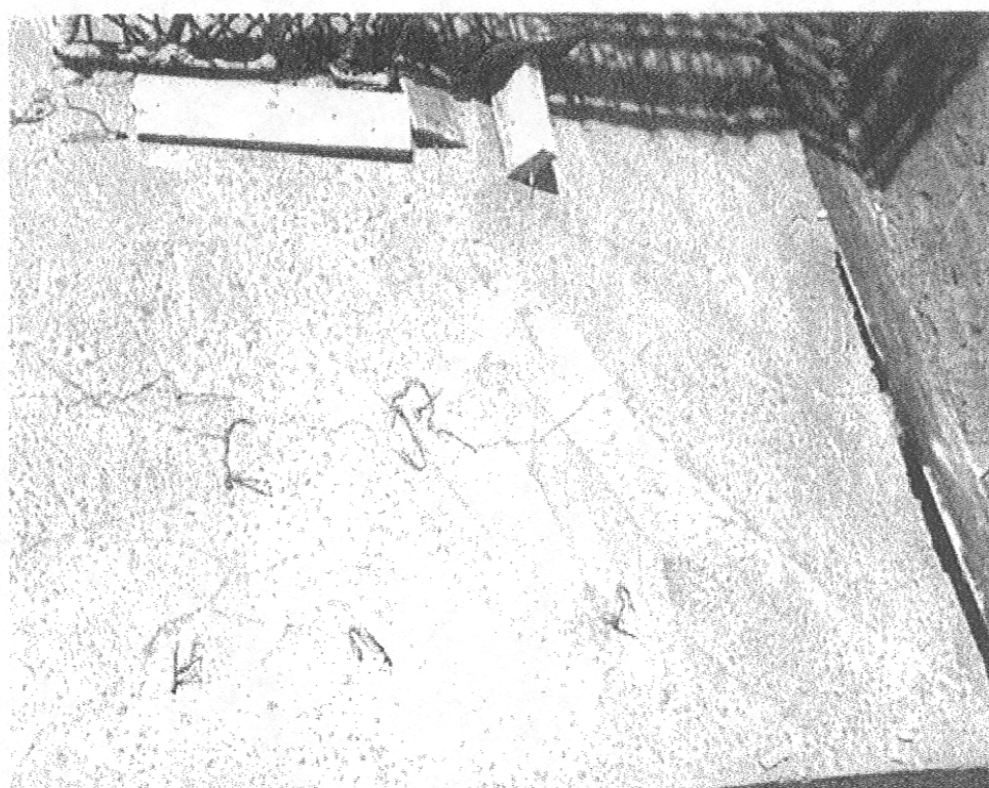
Típica contracción plástica en una losa de concreto.
